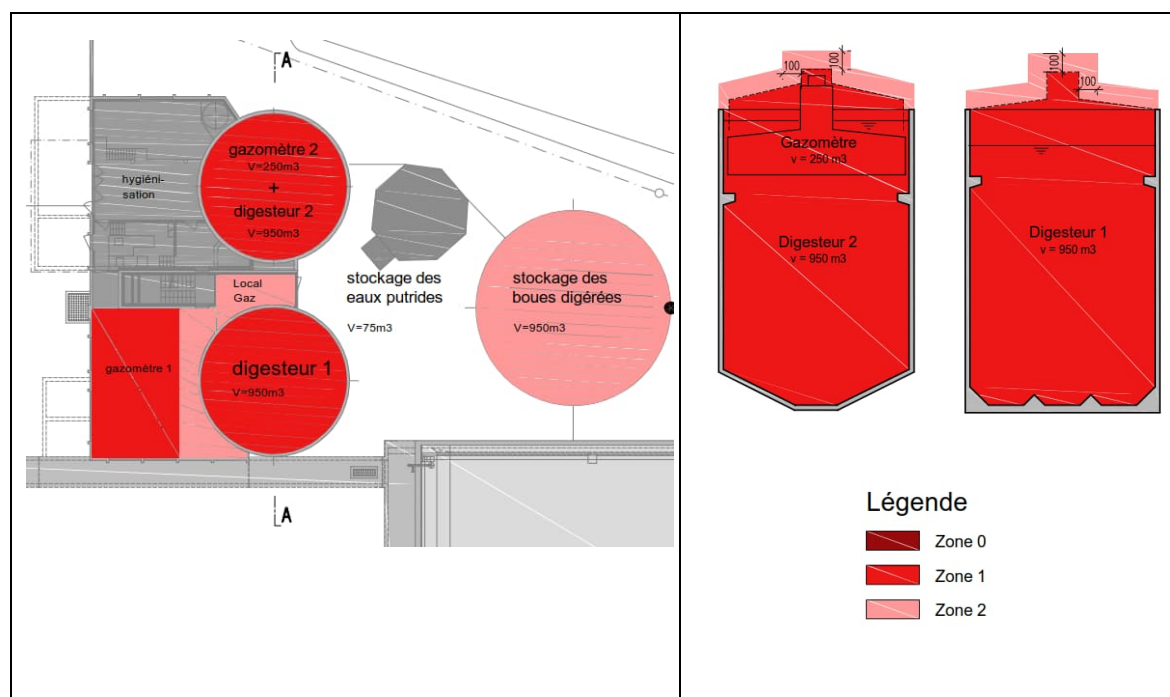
Extrait du plan des zones Ex (source : plan BG n° 4890.01-UP02 du 24.06.2014)
